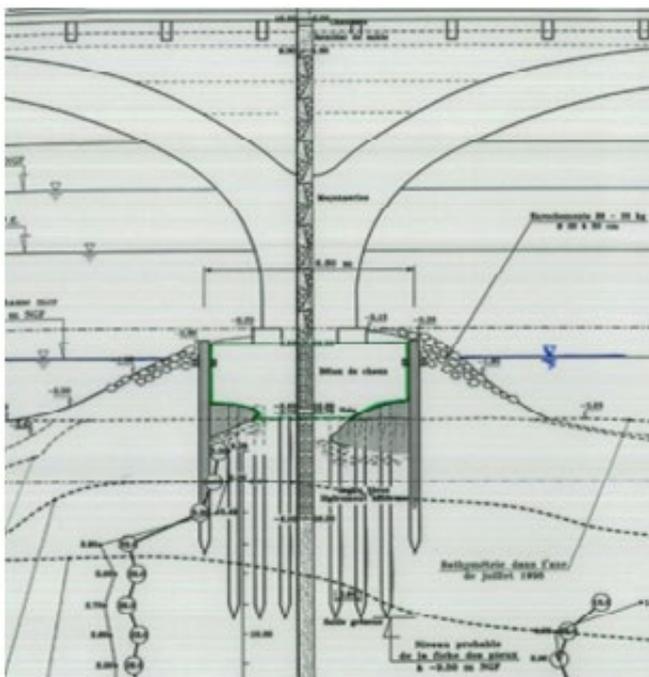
Pont de Port de Lanne sur l'Adour construit en 1875 (image d'archives)
